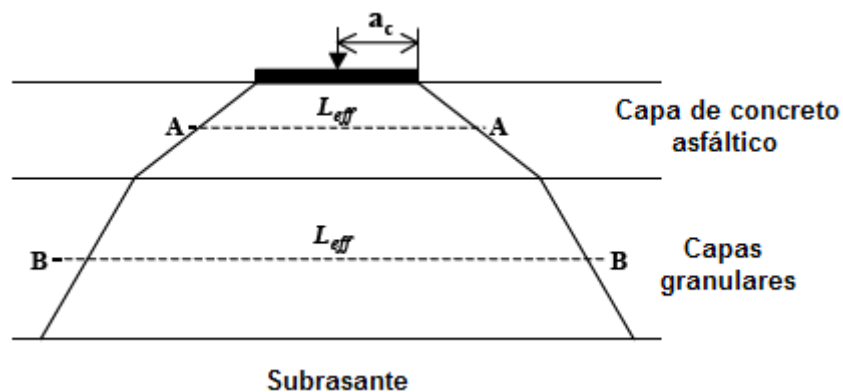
Concepto de longitud efectiva en el sistema de pavimento
